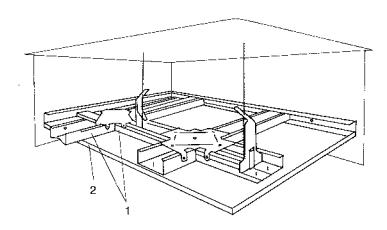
Схема сборки одноуровневого подвесного потолка с металлическим каркасом: 1 — детали каркаса; 2 — листы гипсокартона
